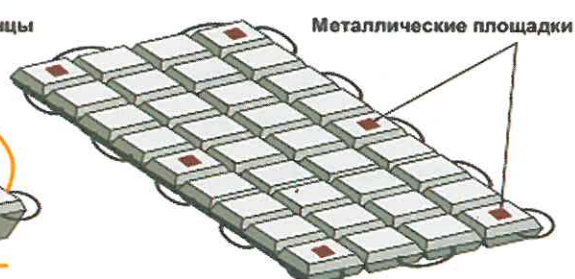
Гибкое бетонное покрытие модификации ПБЗГУ-202 с металлическими площадками
